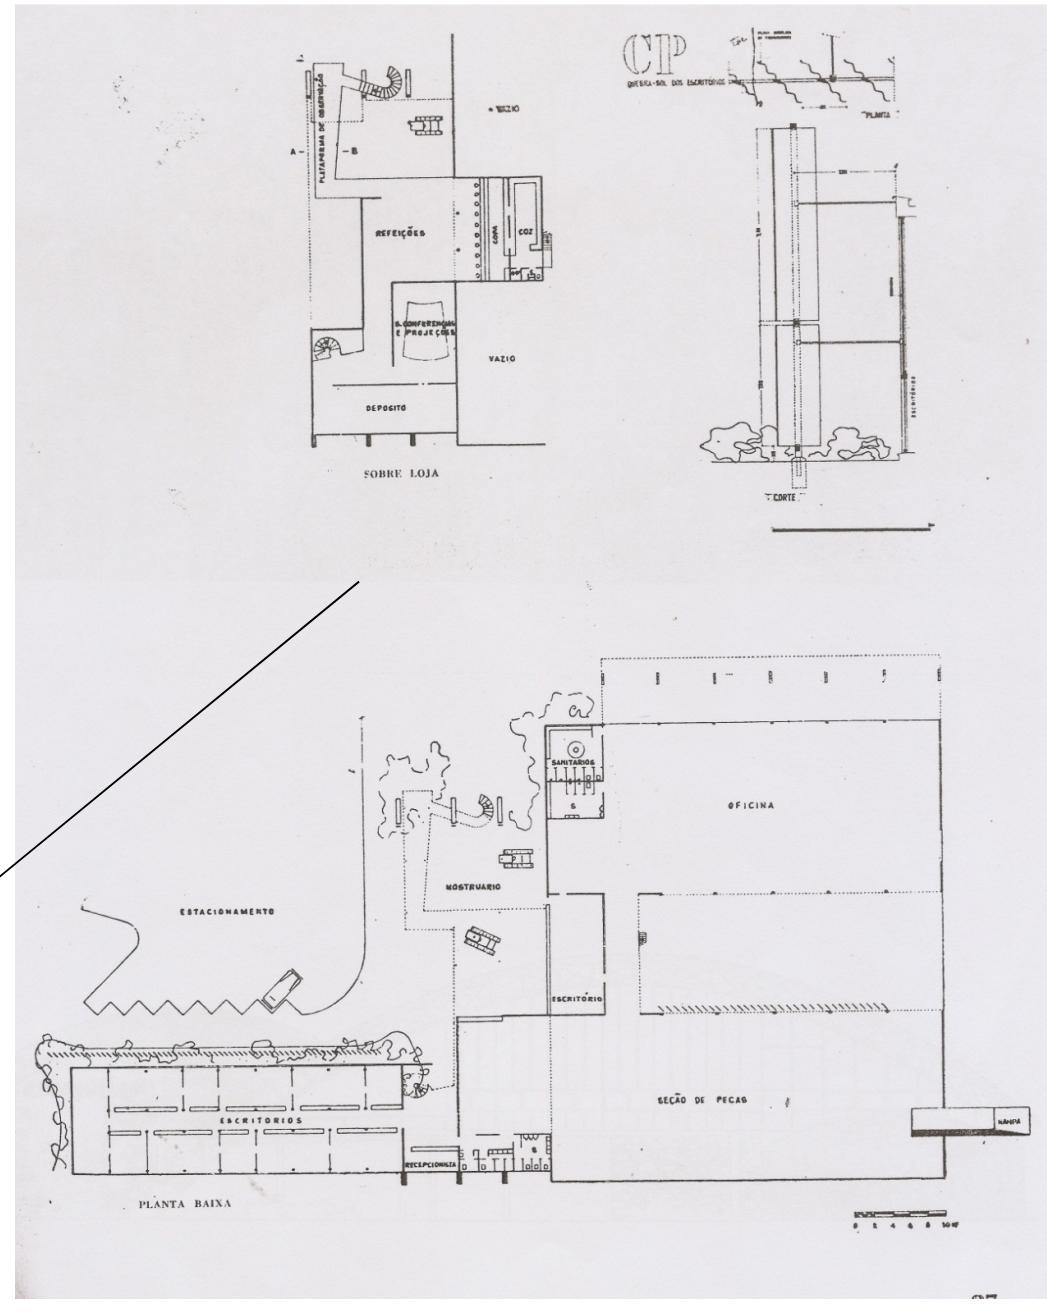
A – Plantas baixas dos pavimentos térreo e sobreloja – detalhe do brise-soleil
